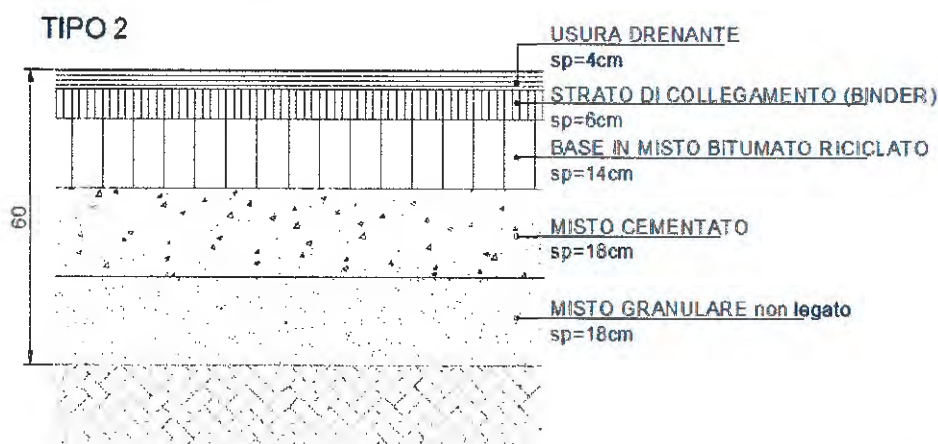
Sezione TIPO 2 proposta variante migliorativa – Rampe Svincolo Sud
